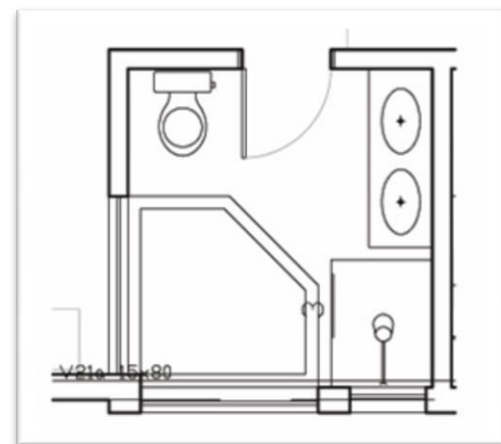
Planta baixa desalinhamento de viga com parede.
